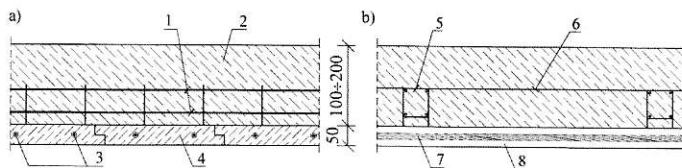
Schemat stropu: a) o pełnym (szczerłym) zbrojeniu dolnym, b) o ażurowym zbrojeniu dolnym: 1 – deski strunobetonowe, 2 – listwy strunobetonowe, 3 – nadbeton, 4 – listwy dolnej warstwy zbrojenia, 5 – listwy drugiej warstwy zbrojenia, 6 – nadbeton
